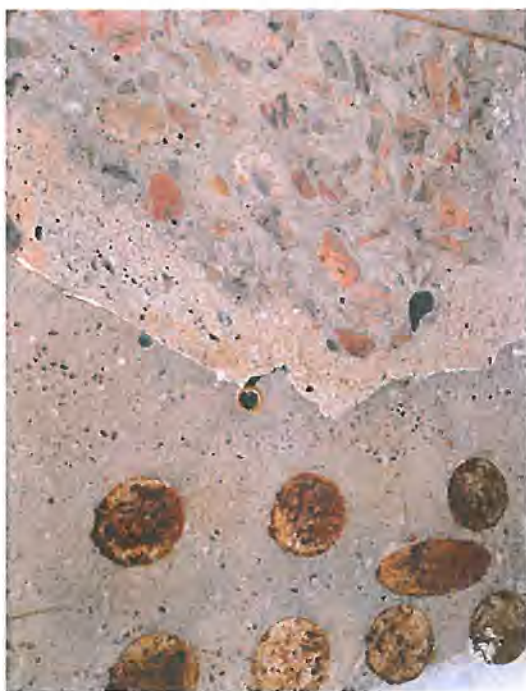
Overgangen mellom ny utstøping i underkant bjelke og opprinnelig betong
